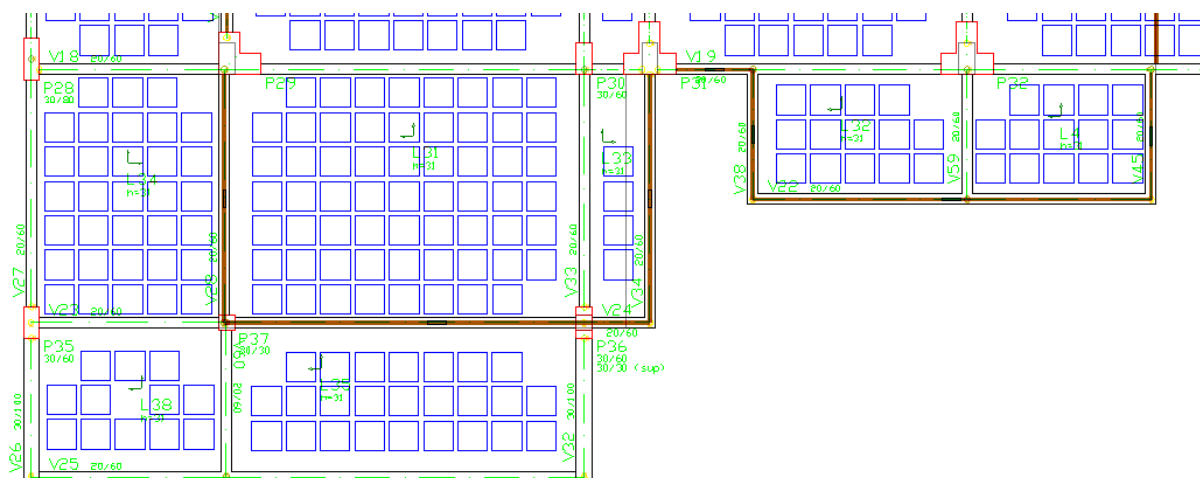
Pavimento Abrigo, da Solução com Laje Nervurada, com novas vigas em balanço
